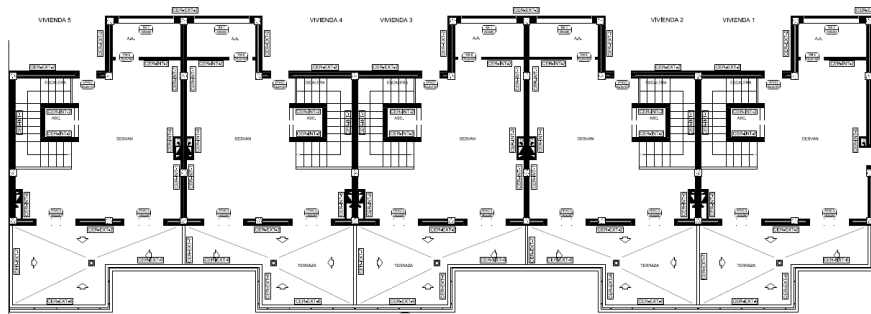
Distribución junta tipo - Planta Cubierta. 2014.
